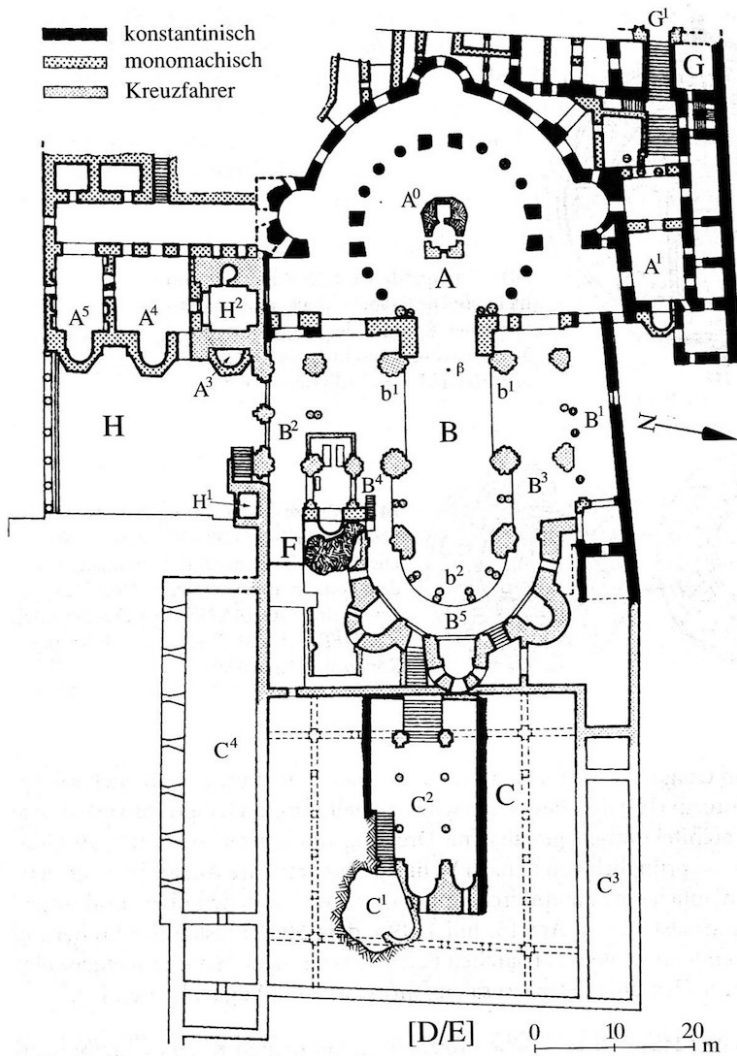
Grundriss Grabeskirche Jerusalem
